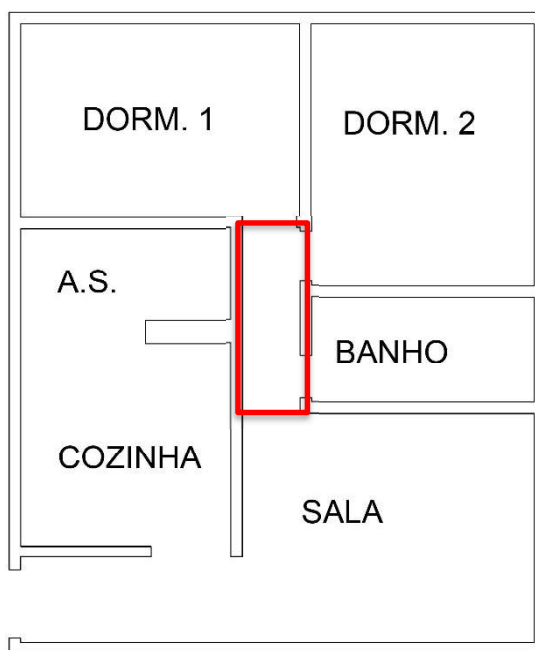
VISTA DA ENTRADA DO BANHEIRO.
